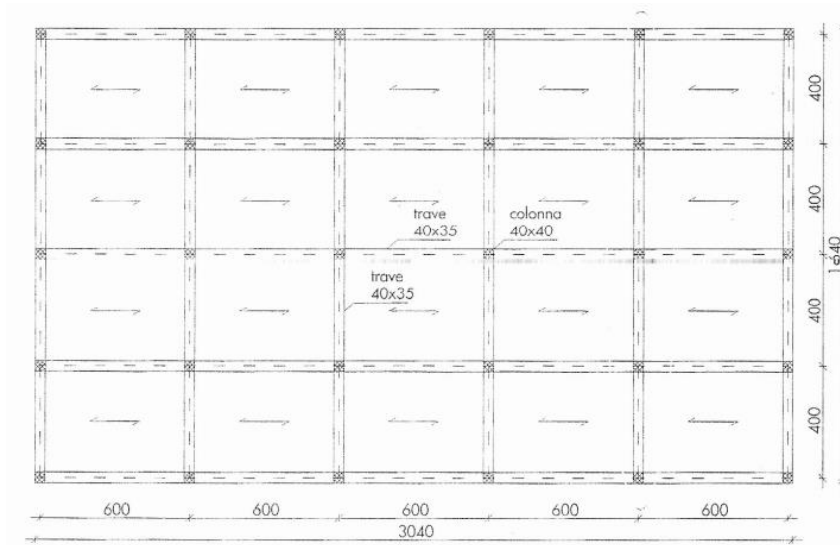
Pianta dell'edificio tipo con indicazione del telaio scelto.
